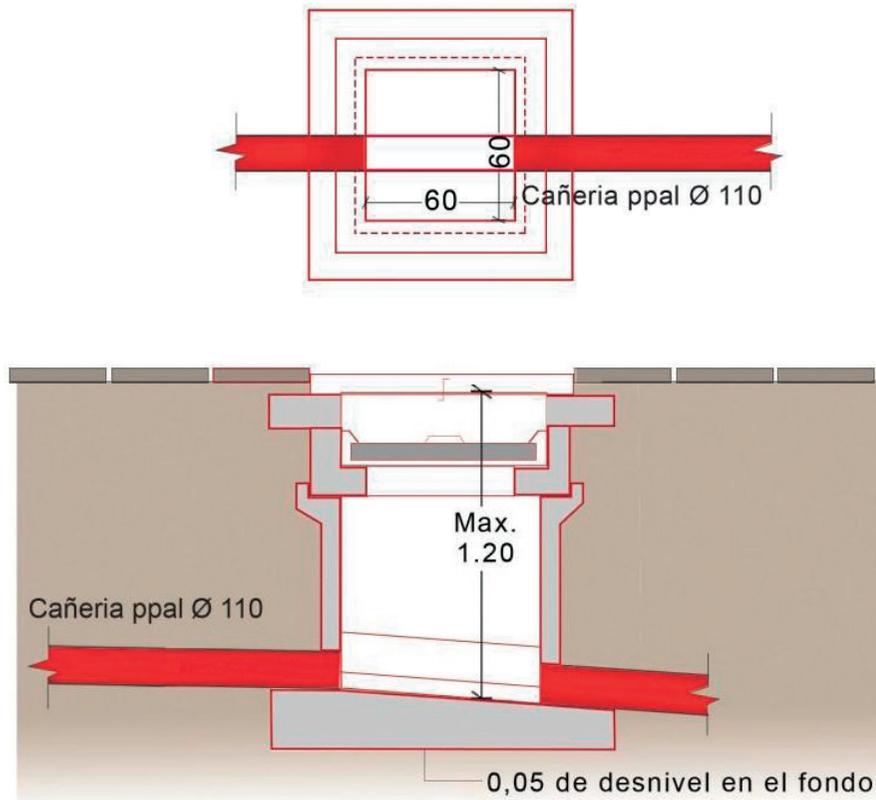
Cámara de Inspección de hormigón. Planta y corte.
